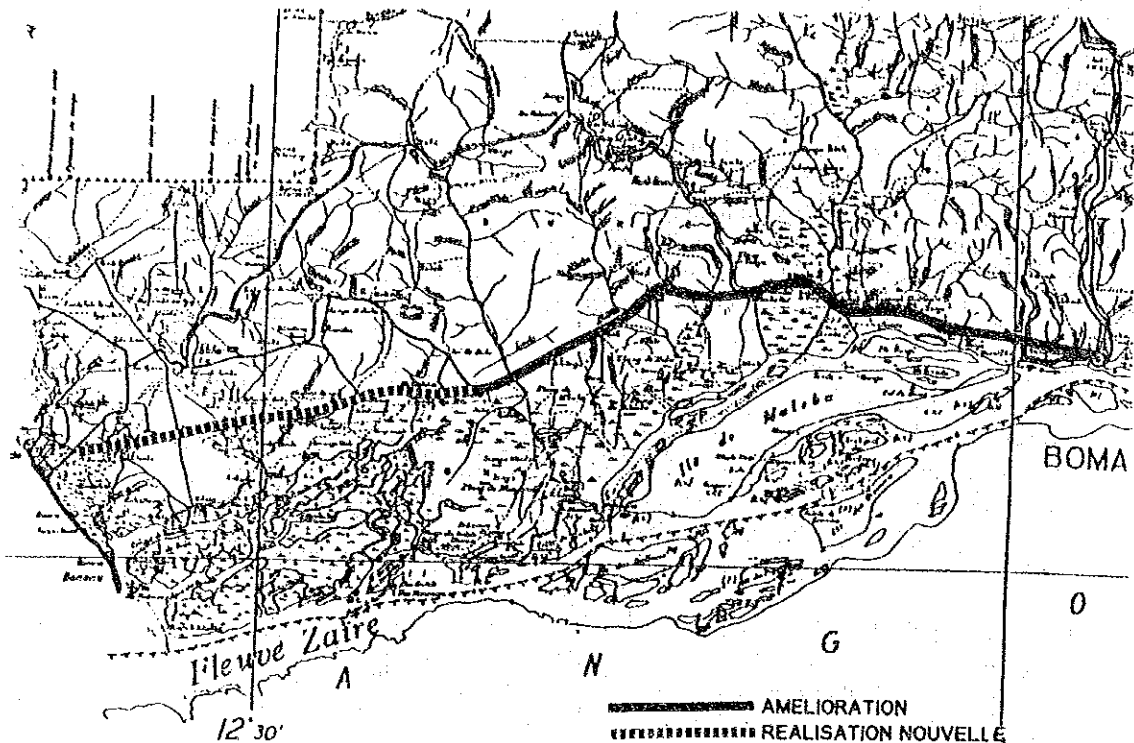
Plan d'aménagement routier Boma/Banana
